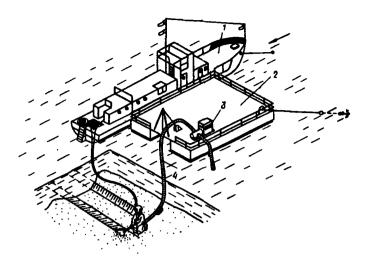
Схема разработки грунта гапромонитором 1 — водолазный бот; 2 — плевушя площадка; 3 — гидромонитор; 4 — напорный шланг гидромонитора
